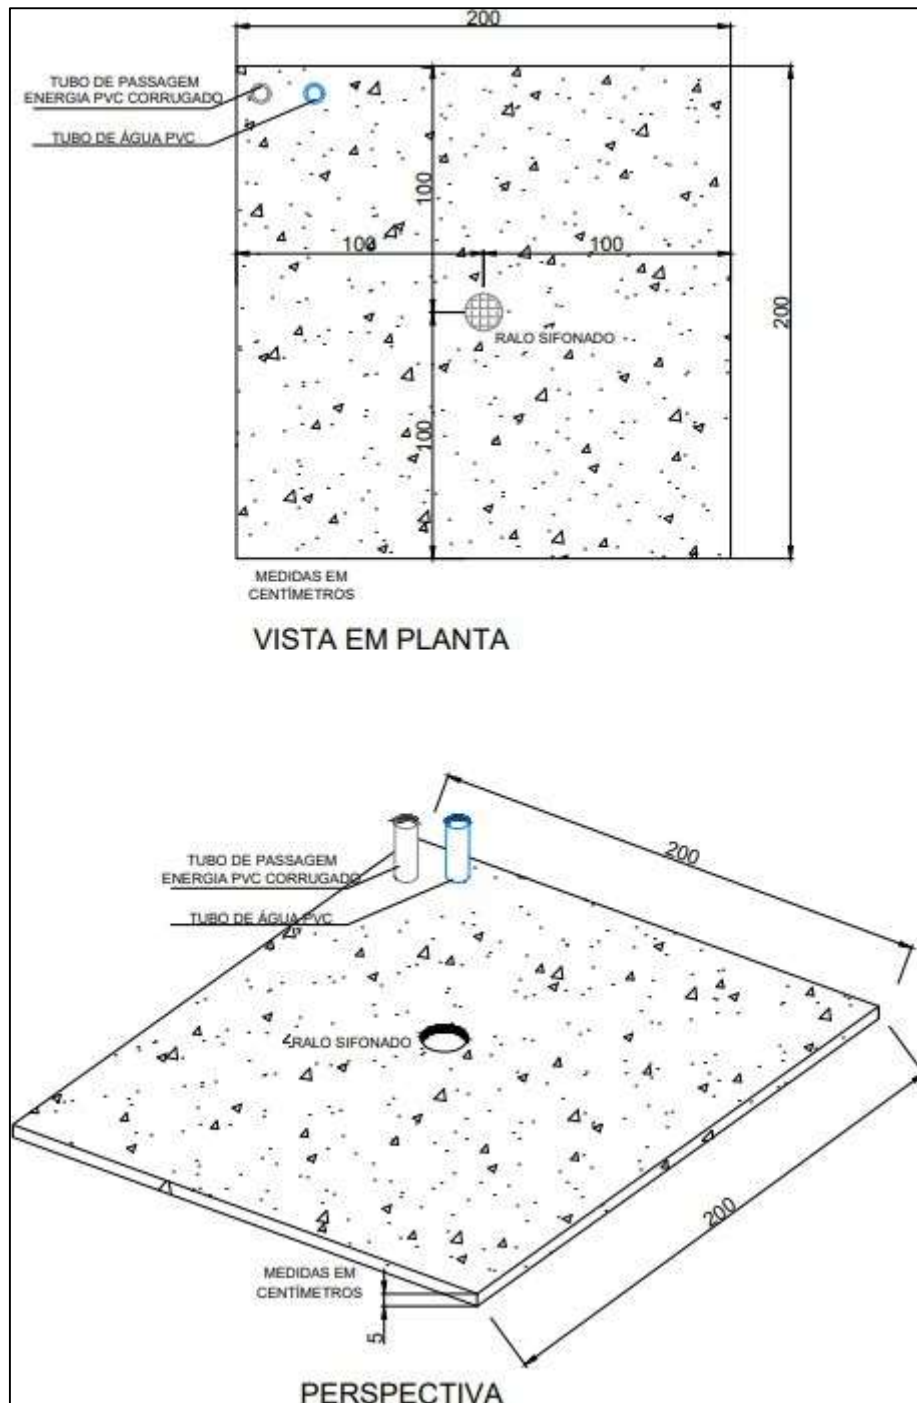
Croqui da base dos totens - Elaboração Samae 2025
